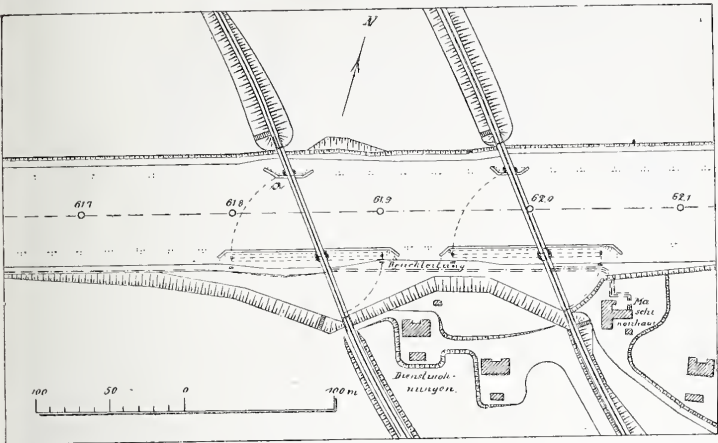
Lageplan der Eisenbahndrehbrücken bei Osterrörfeld.
